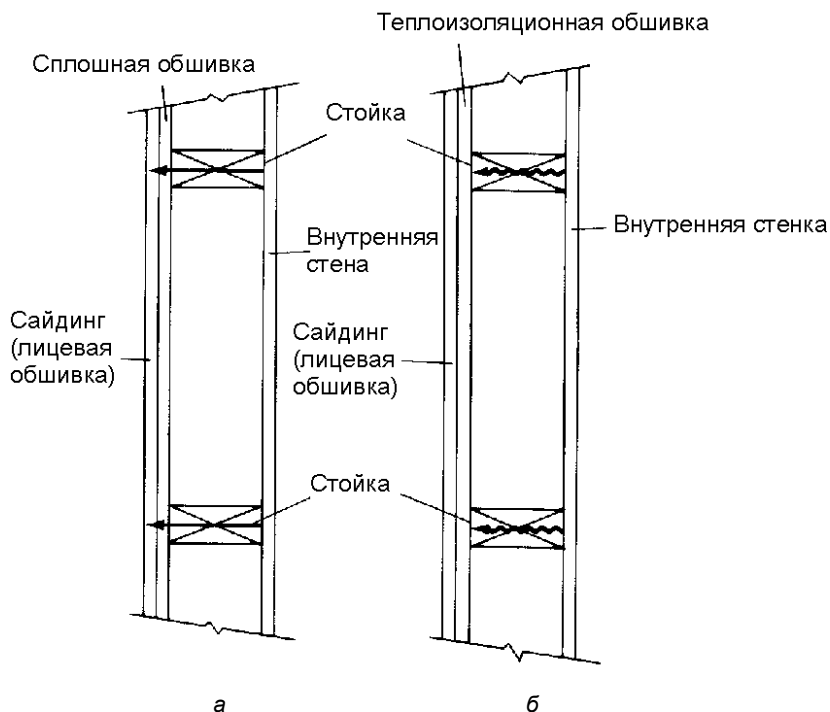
Сравнение конструкции стен: а — сплошная обшивка и стойки стены представляют собой непрерывный путь для теплопередачи; б — теплоизолированная обшивка создает барьер теплопередаче
